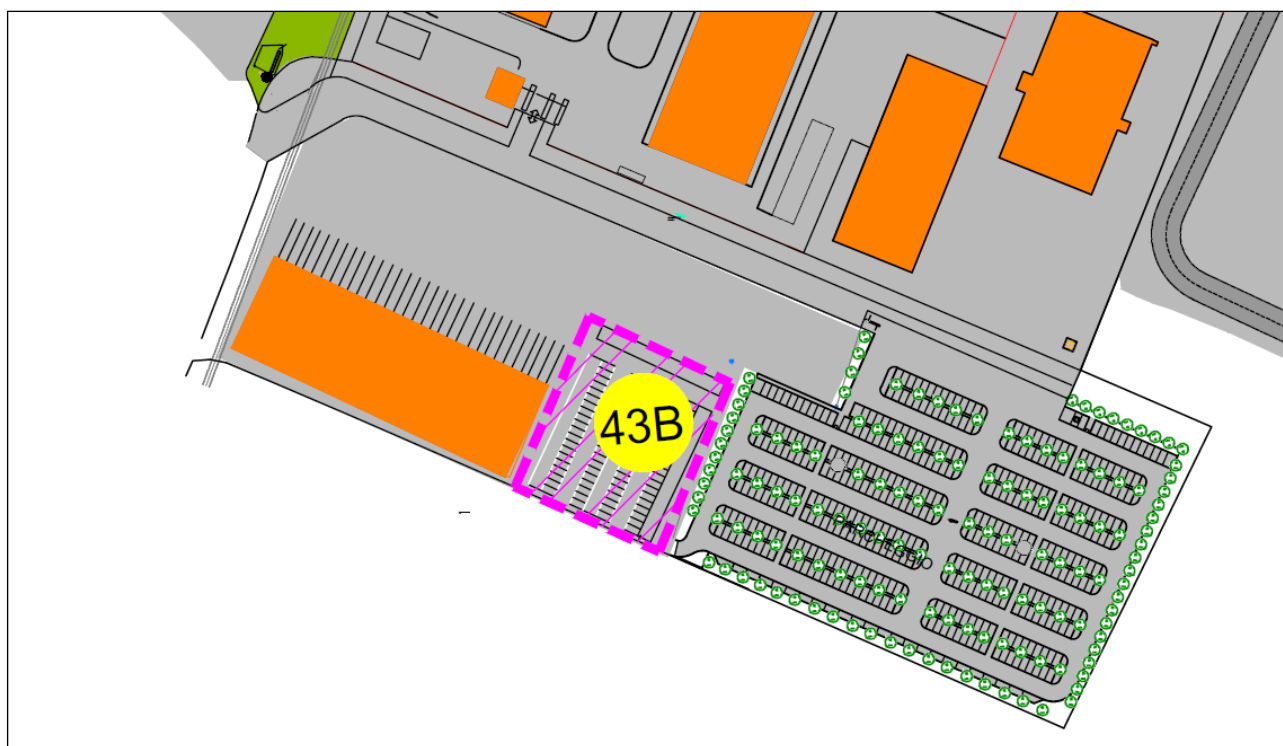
Estratto Master Plan – Parcheggi e Viabilità Area Spedizionieri
